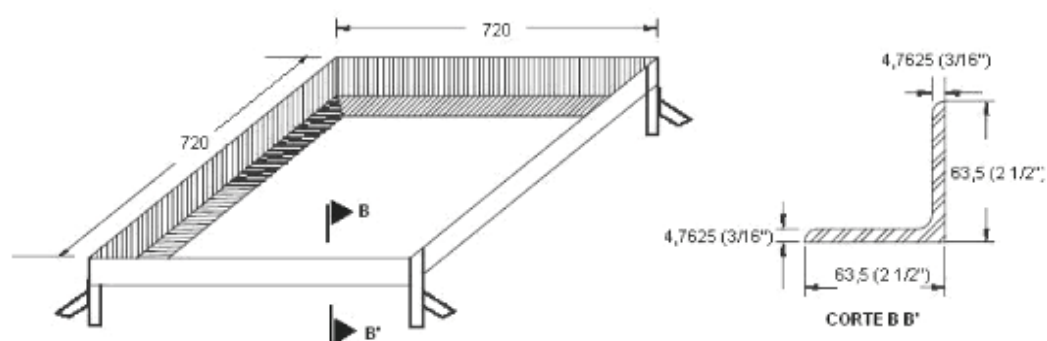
Caja de inspección BT, vista de planta con marco.
